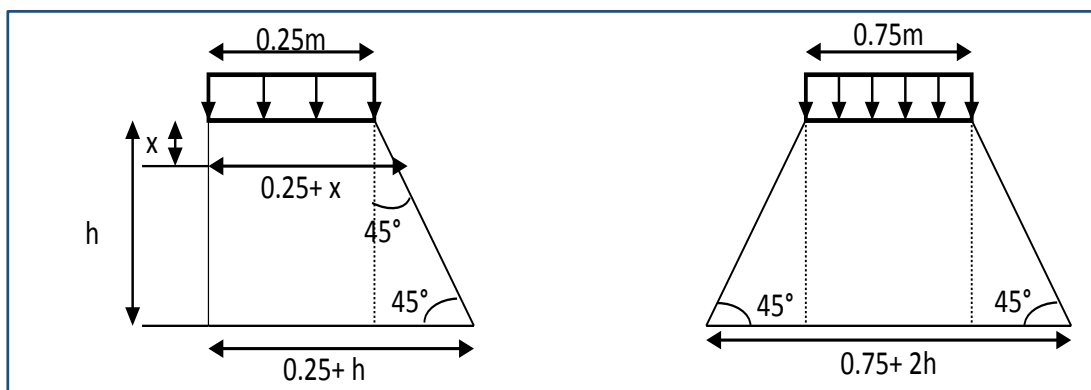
Poussée de la charge locale située en arrière du mur.
